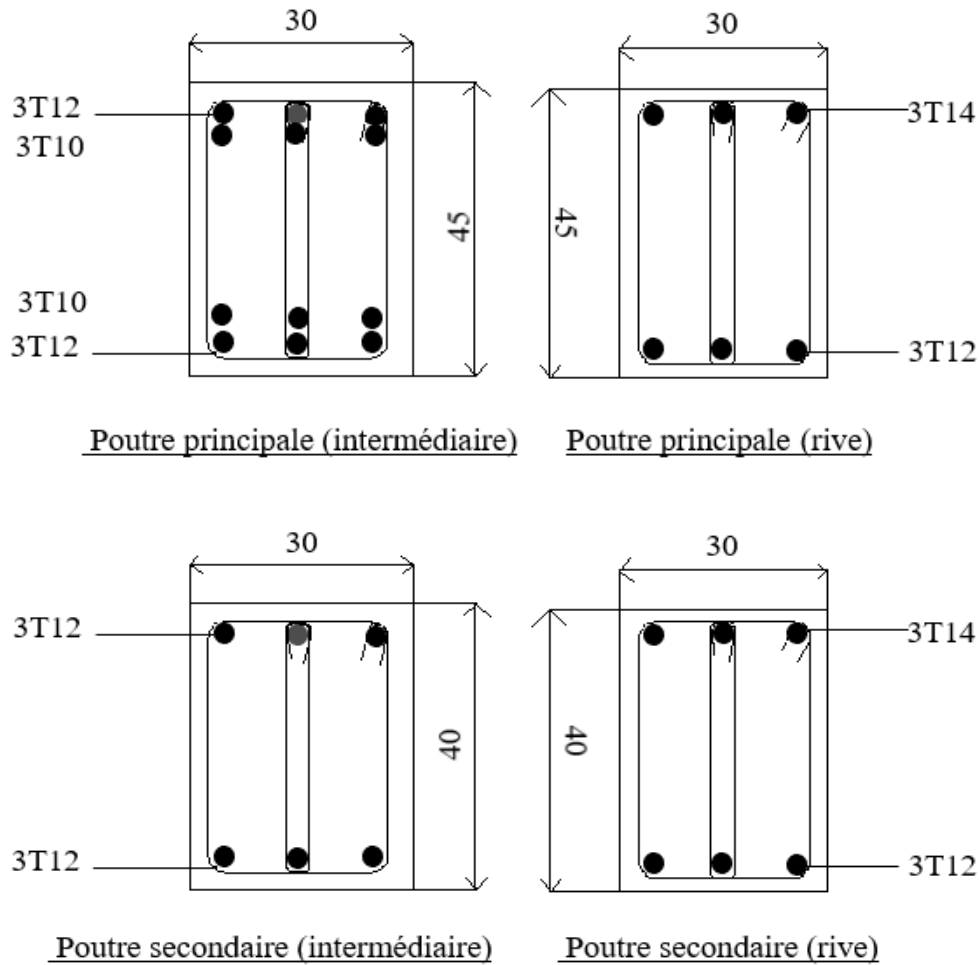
Disposition du ferrailage des poutres (Terrasse et étages).
